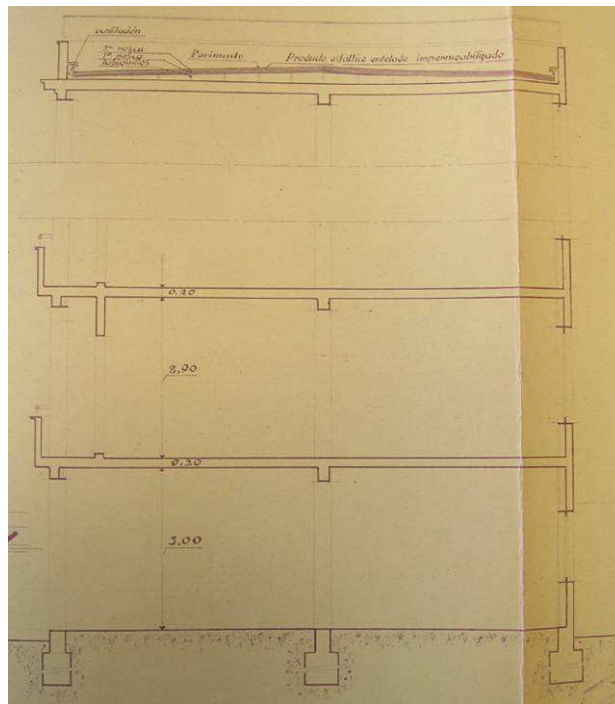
Sección acotada. Edificio ficha 73C.010, 1941.
